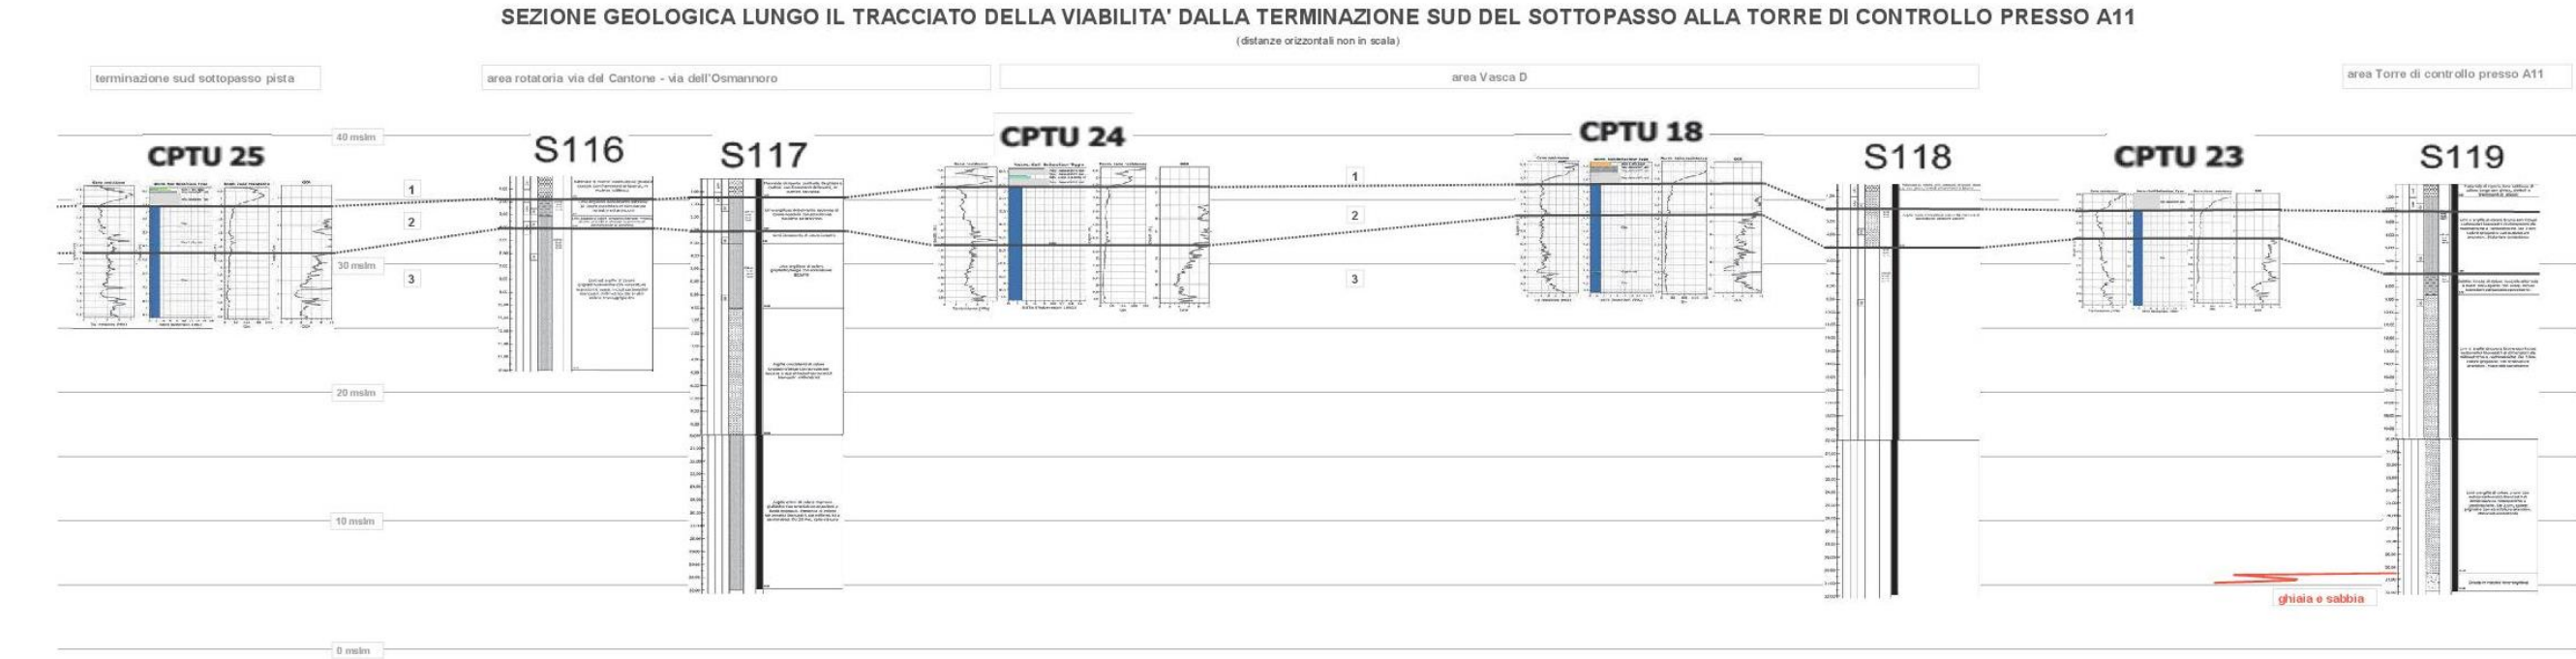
Sezione geologica tracciato viabilità dalla terminazione sud del sottoattraversamento pista alla torre di controllo presso Autostrada A11.
